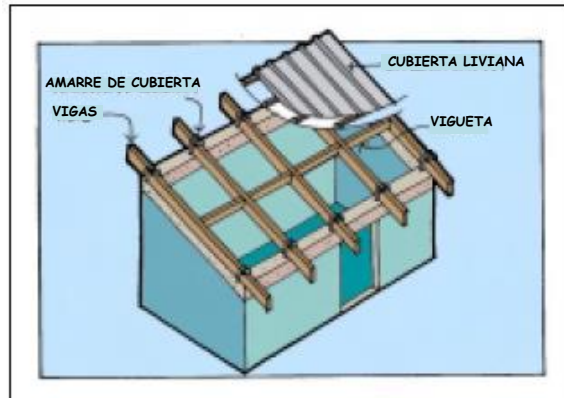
Amarre de cubiertas - Chavarría (2001)
